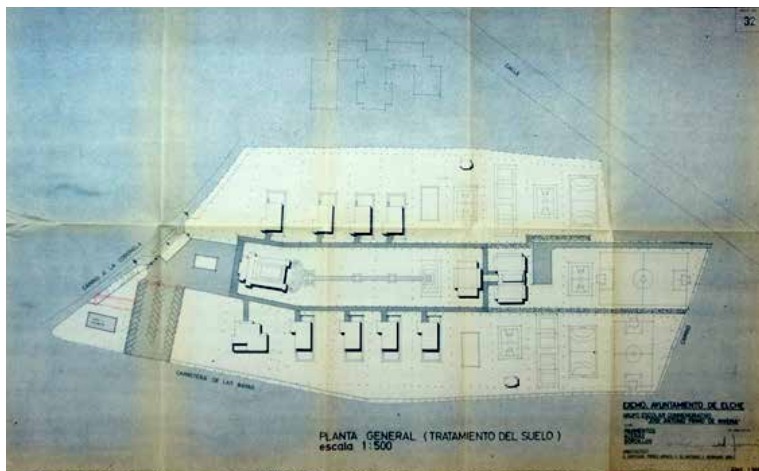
Planta general: paviments, sòl i voreres, 1969.
